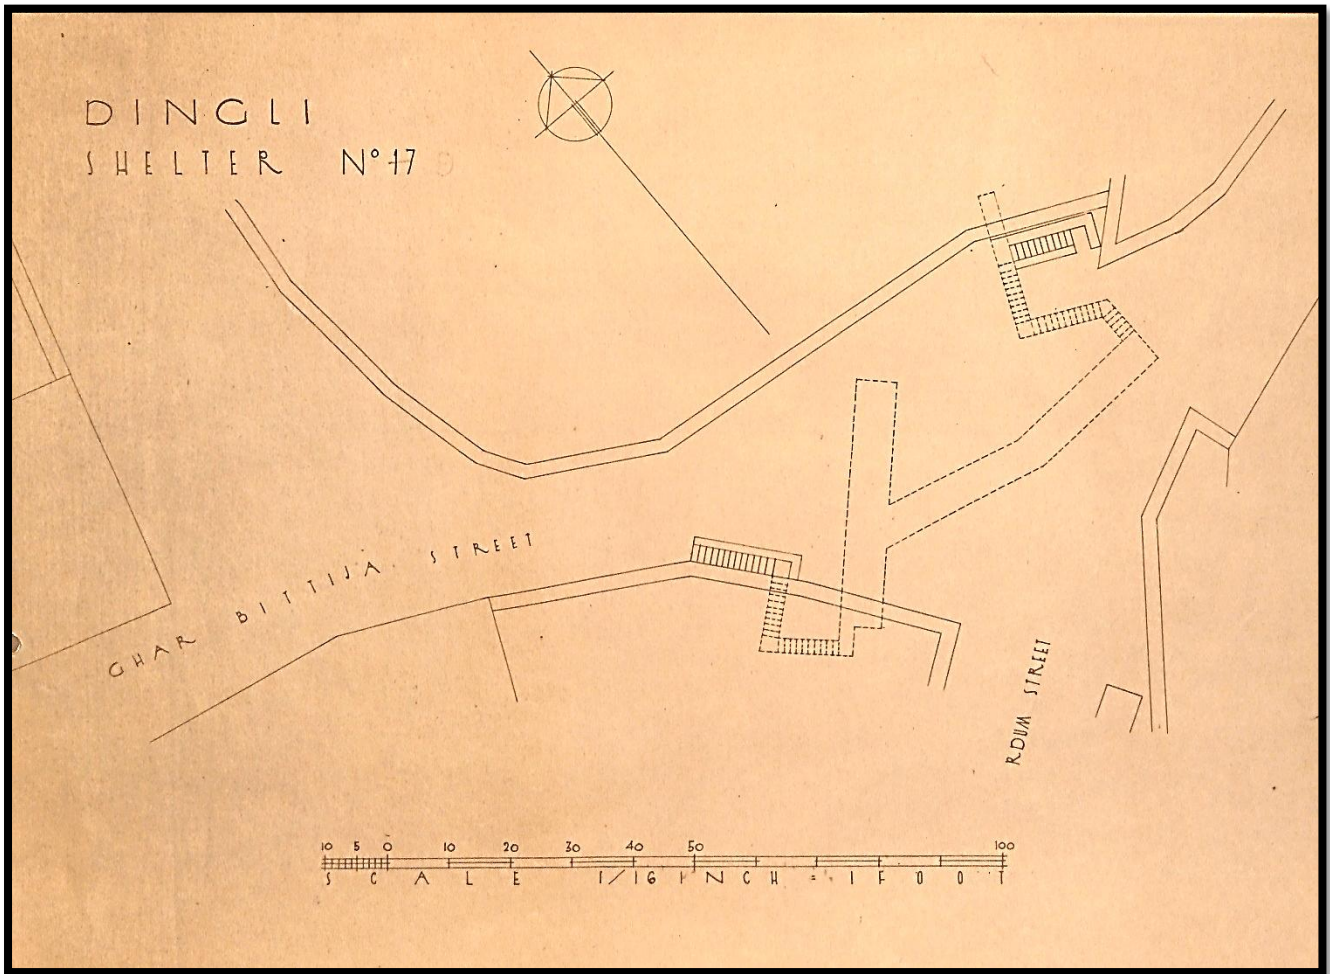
Planta do Abrigo nº 17 (9) "Ghar Bitija Street – Rdem Street"
